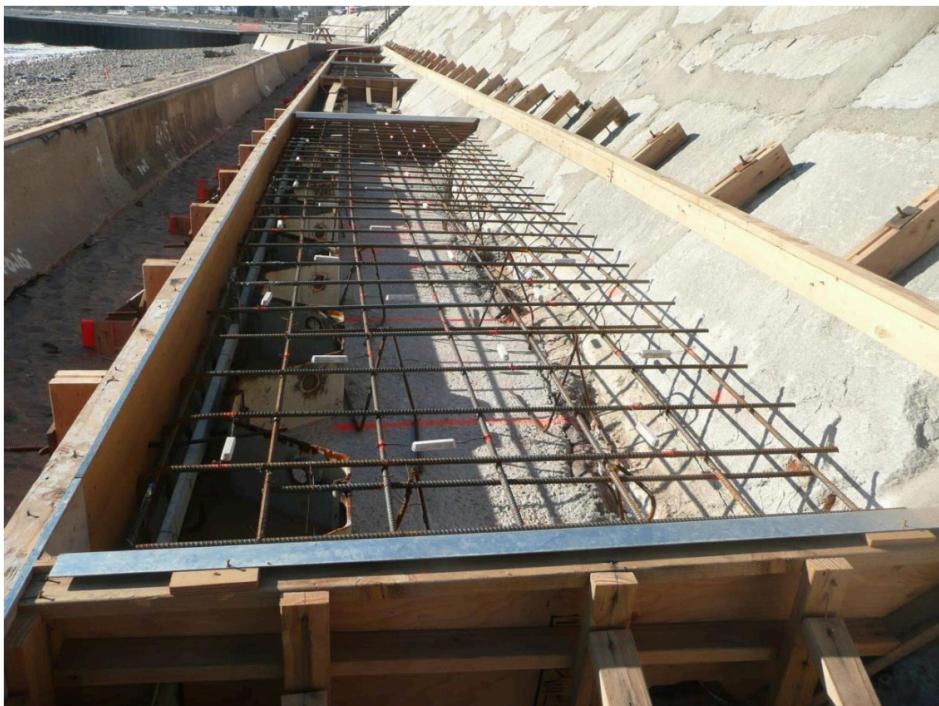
Instalação de anodos de proteção catódica em uma obra de concreto em construção. Os anodos são fixados às ferragens antes da concretagem.
